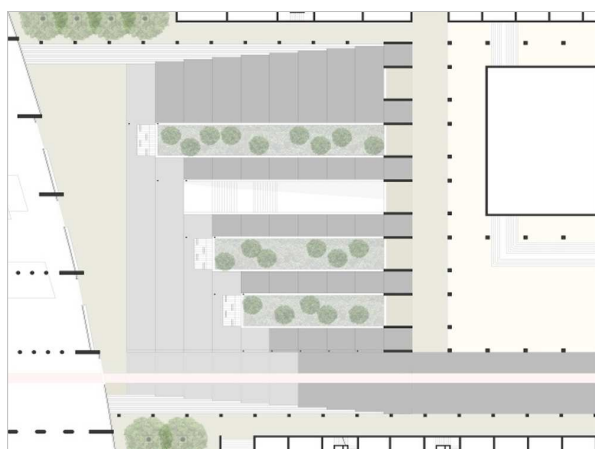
Planta do espaço exterior adjacente ao mercado.
